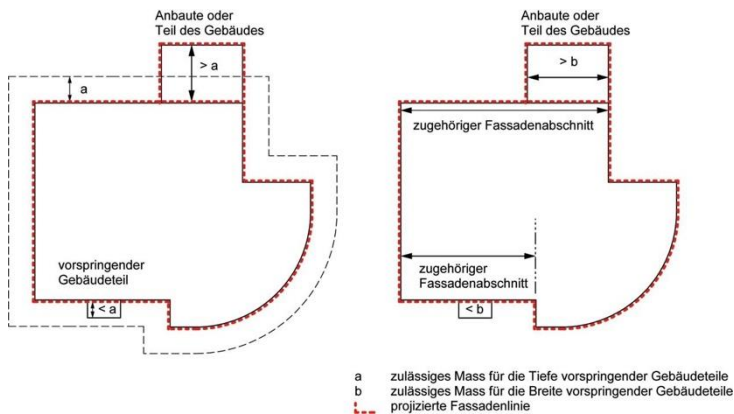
3.3 Fassadenflucht und Fassadenlinie
